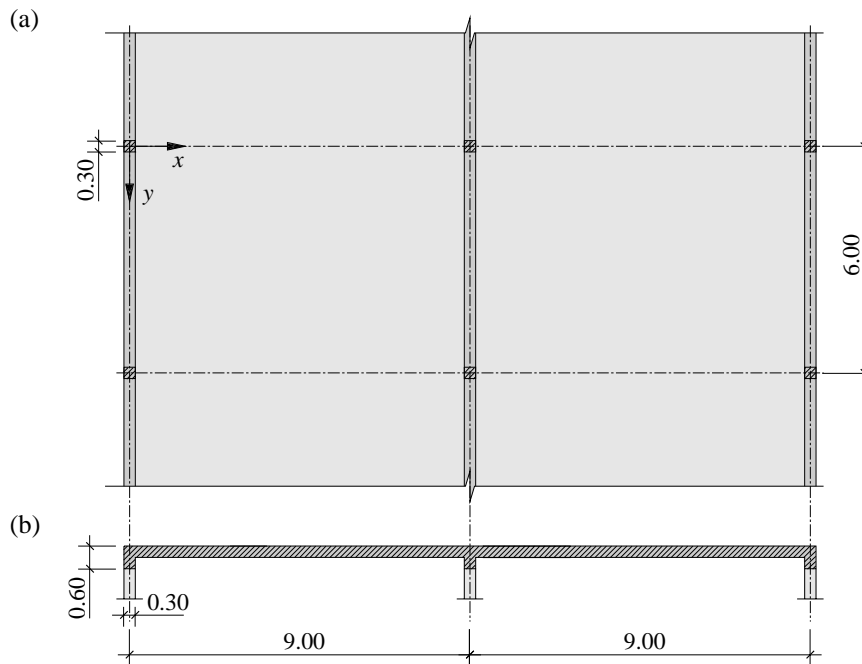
In Aufgabe 3 behandelte vorgespannte Stahlbetondecke: (a) Grundriss; (b) Längsschnitt. Abmessungen in m.
